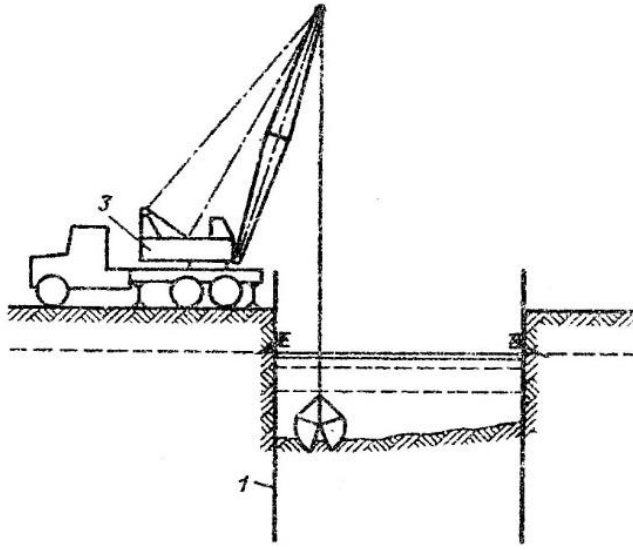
Розробка ґрунту в котловані, який огорожений шпунтом
